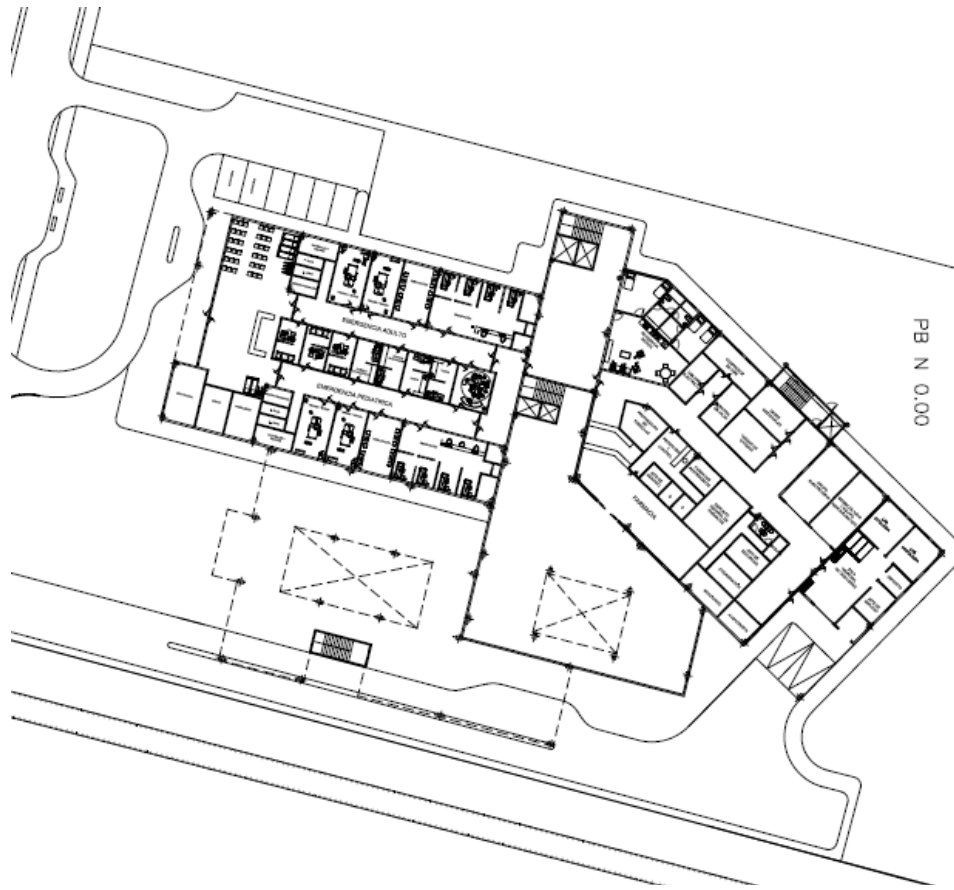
Planta baja conjunto del Hospital Tipo I. Fuente: PDF. (2018)
